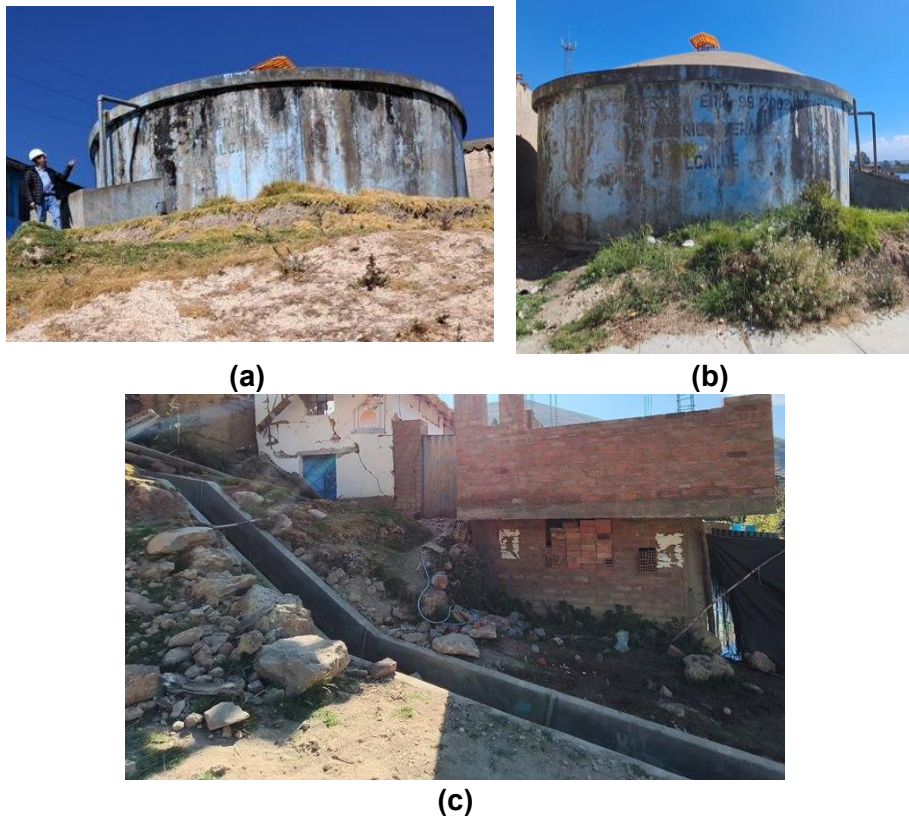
Reservorio y Canal de Drenaje Pluvial de Chongos Bajo
